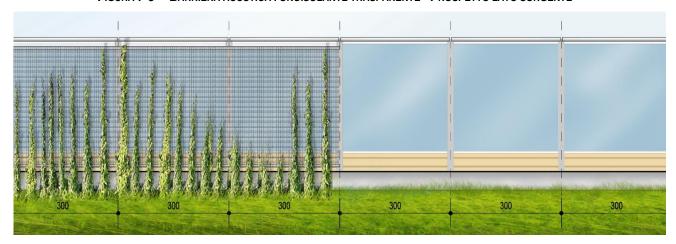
BARRIERA ACUSTICA FONOISOLANTE TRASPARENTE – PROSPETTO LATO RICETTORE
